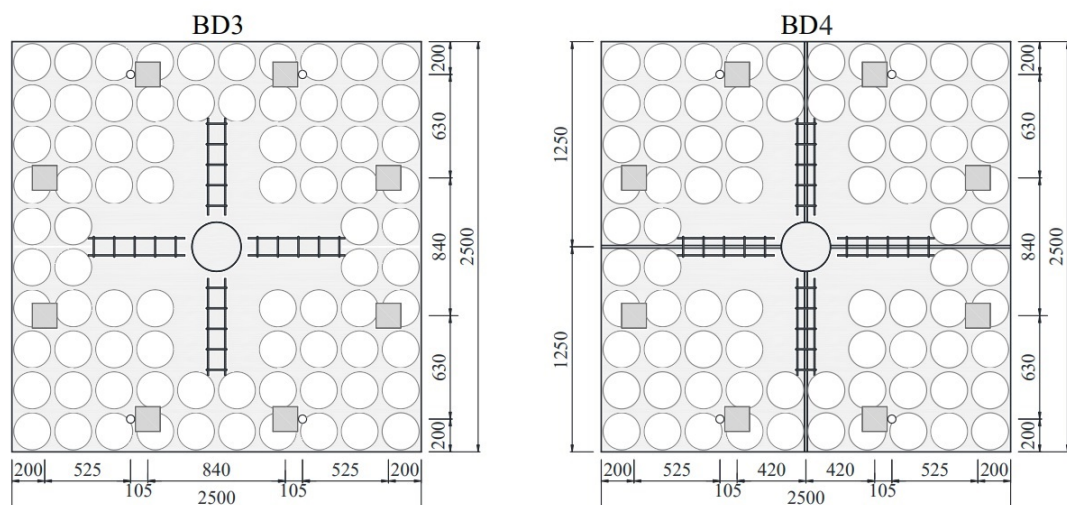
Lajes da terceira série de concretagem (dimensões em mm) (fonte: Nicácio (2018))
